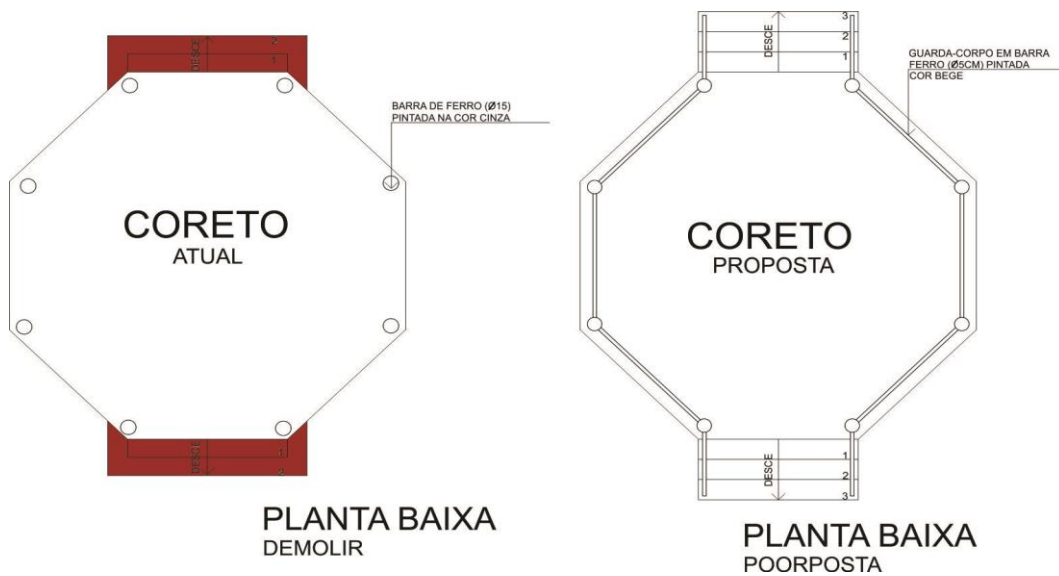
Planta baixa da proposta para o Coreto com a indicação do guarda-corpo em barras de ferro.
